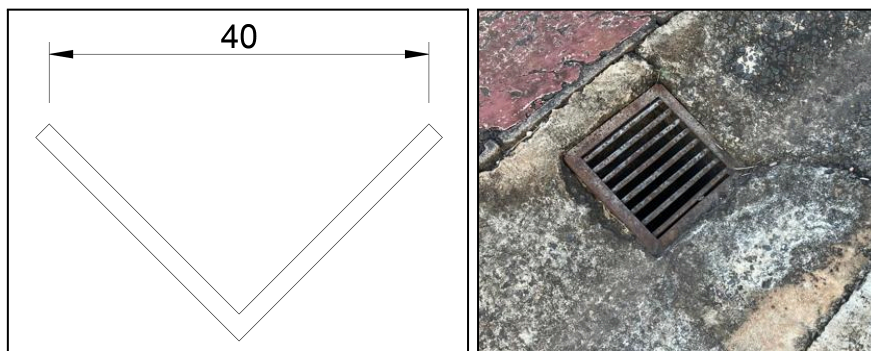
Modelo das canaletas e grelhas a serem construídas e fornecidas/ substituídas respectivamente.
